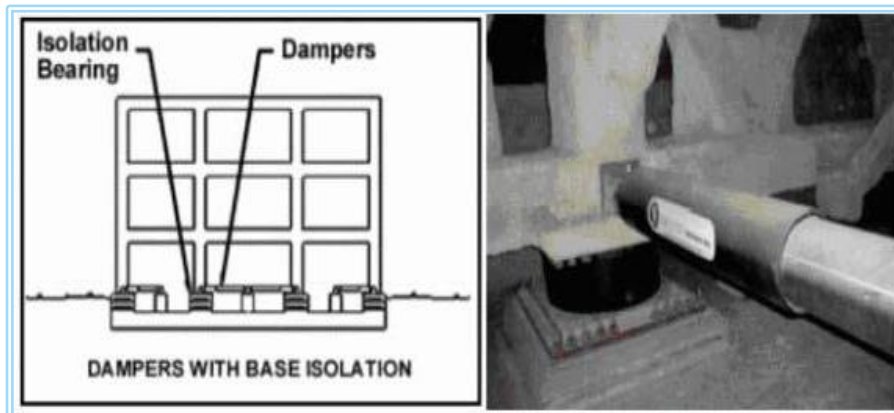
Disposición horizontal con sistema de aislamiento basal.
